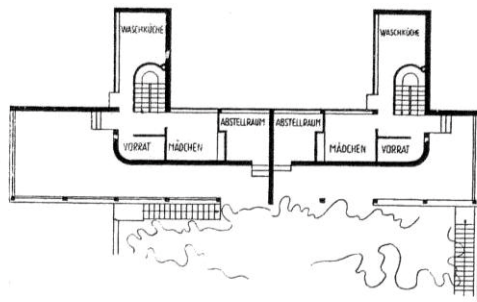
Grundriss des Doppelhauses von Le Corbusier und Pierre Jeanneret auf dem Stuttgarter Weißhof, 1927.
